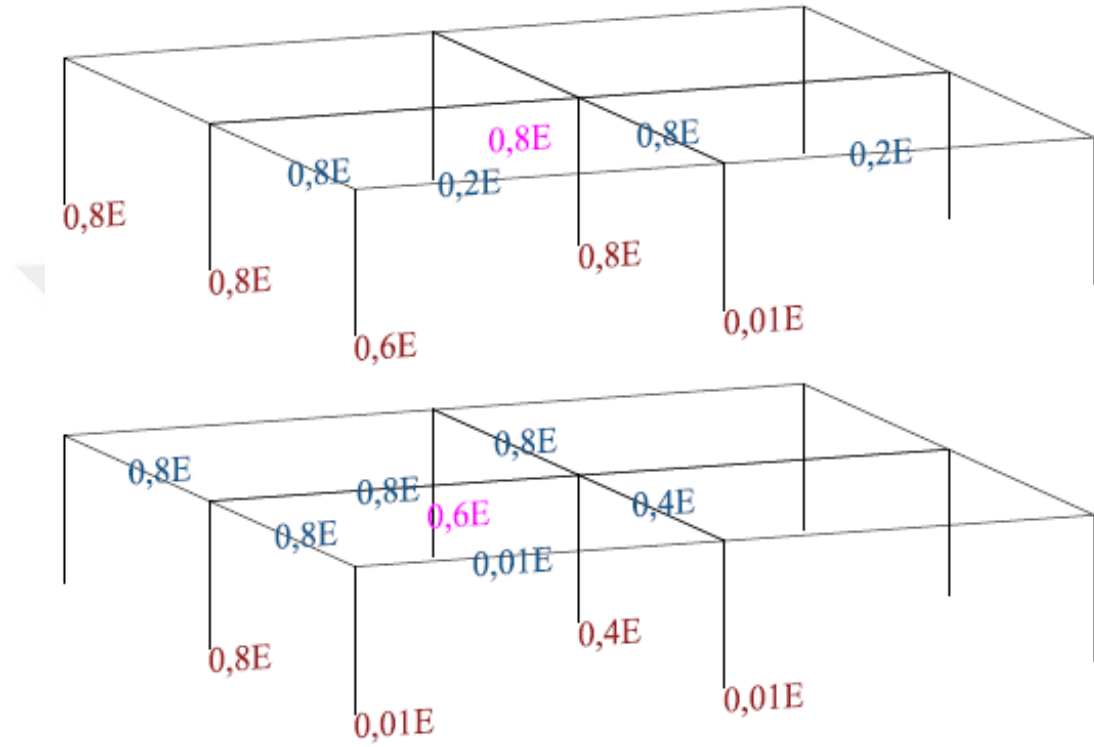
Betonarme taşıyıcı sistemin patlama sonrası servis yükü altında betondaki gerilme dağılımı
